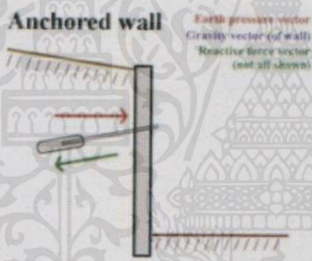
กำแพงกันดิน Piling Wall [บรรณาธิการเว็บไซต์บ้านและสวน ,2557]
